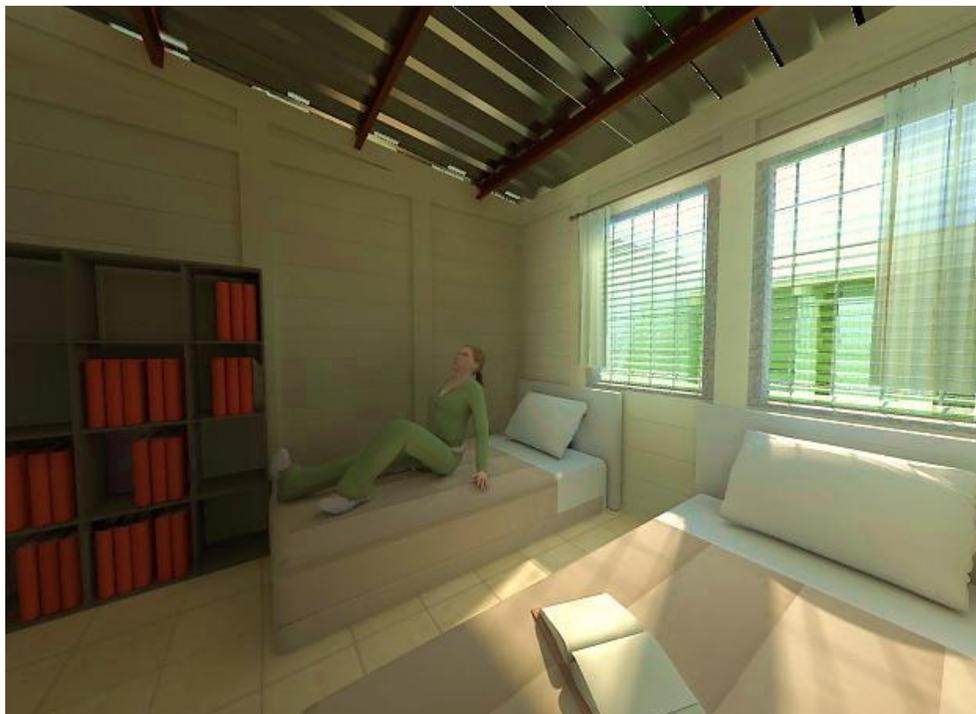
Propuesta de Vivienda (Vistas Interior Zona Privada).
